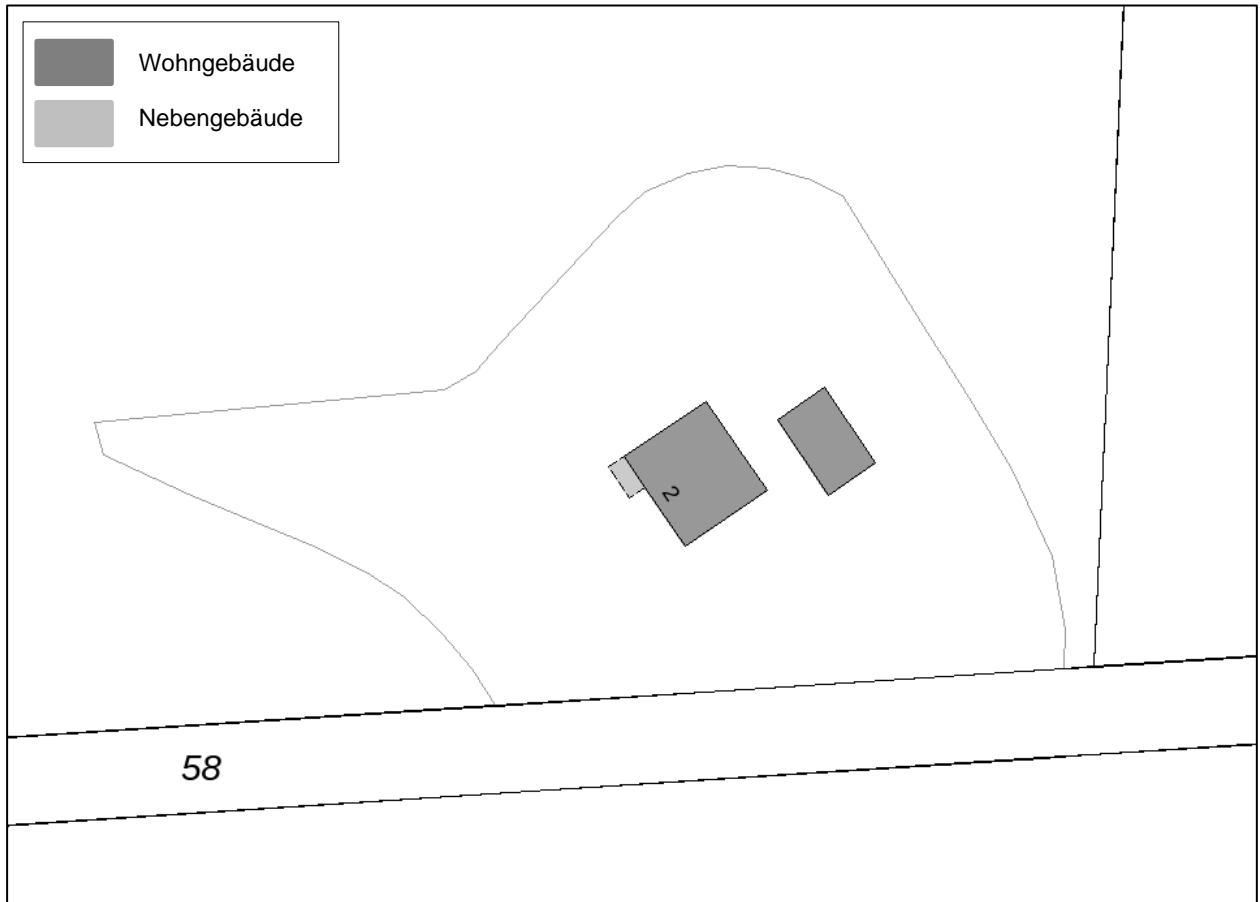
BP9 Wohnhaus ,Delbrück-Steinhorst, Steinbreite 2' – Lageplan [6]
